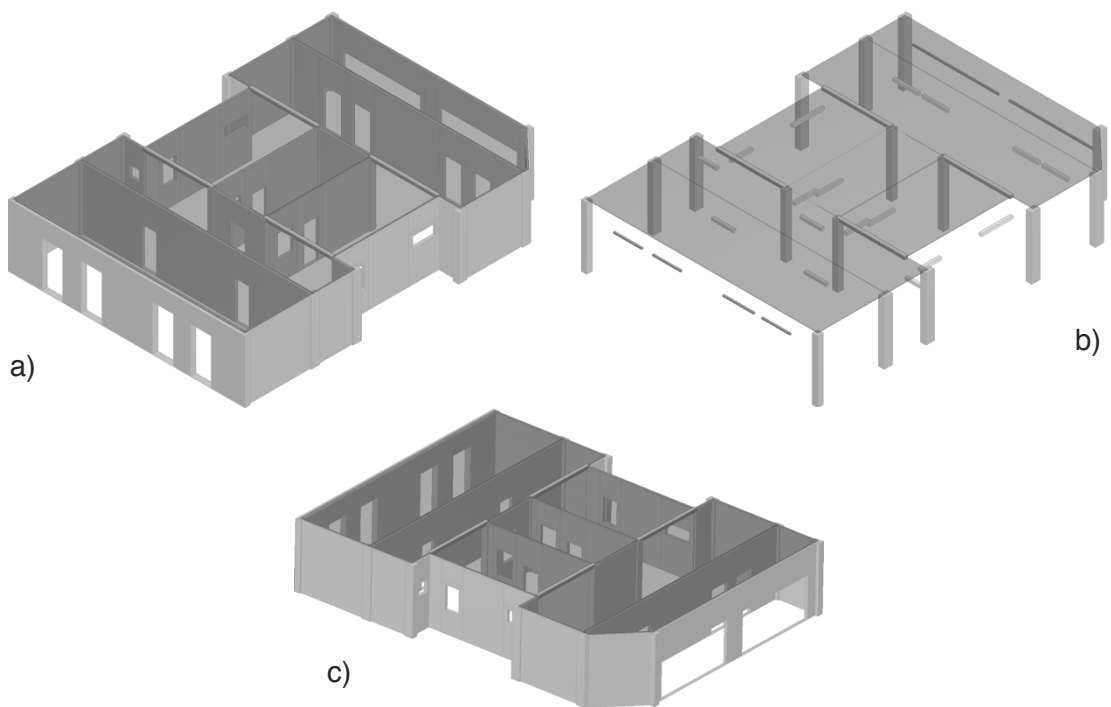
Modelo Tremuri edificio ED-03 planta tipo. a) Vista isométrica fachada principal. b) Vista isométrica fachada principal sin muros. c) Vista isométrica fachada trasera
